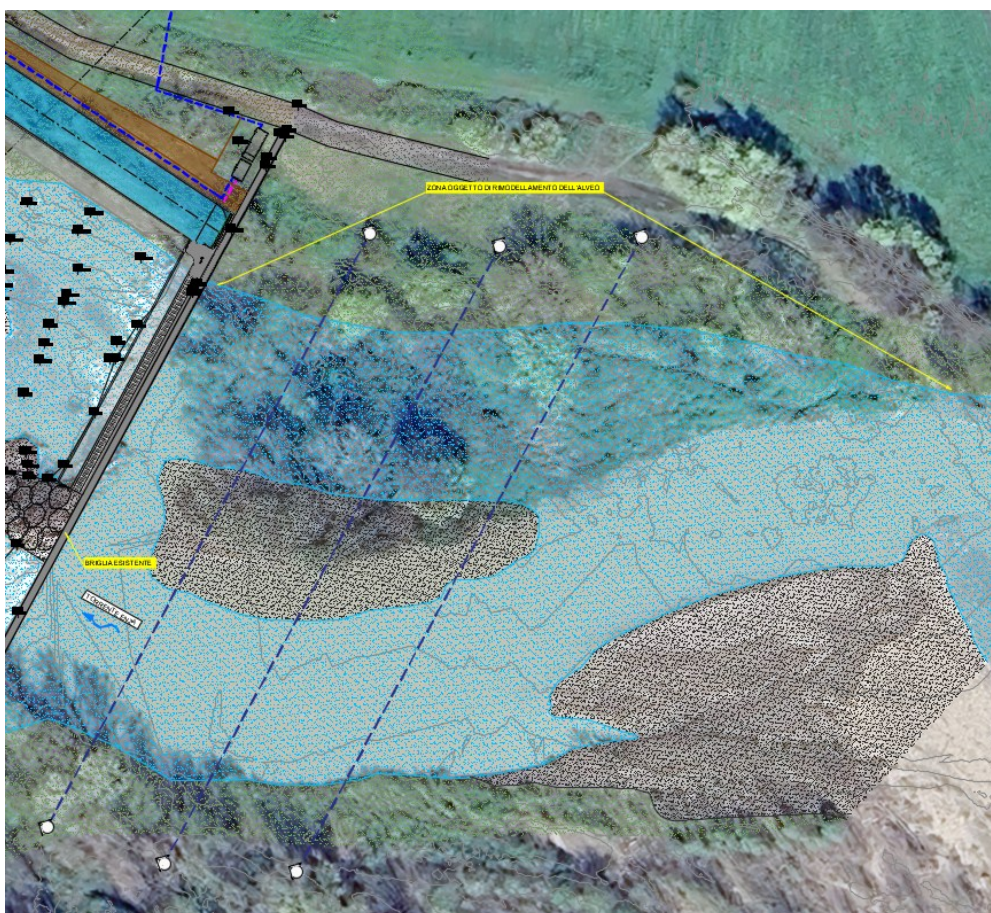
Planimetria dell'intervento compensativo proposto a monte della briglia
